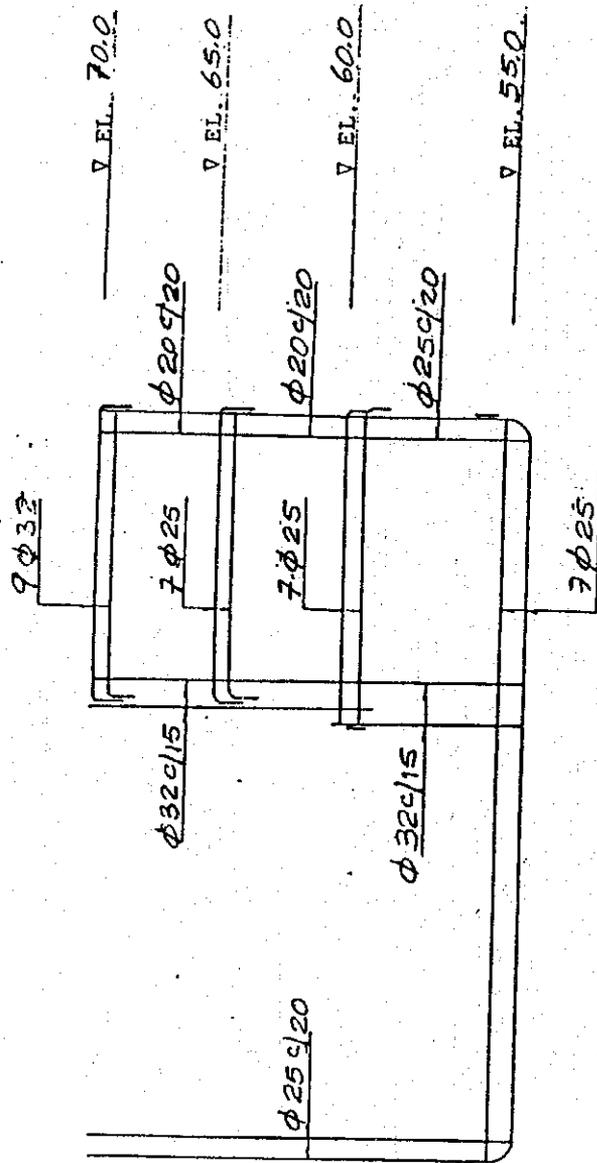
(f) E-E ( VIGA Y COLUMNA )
